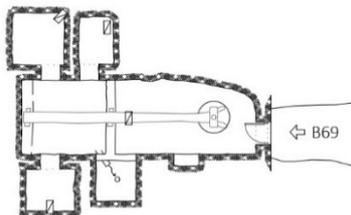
Planta bodega SRH_B69. Escala: 1/400. Fuente: *Elaboración del autor.
